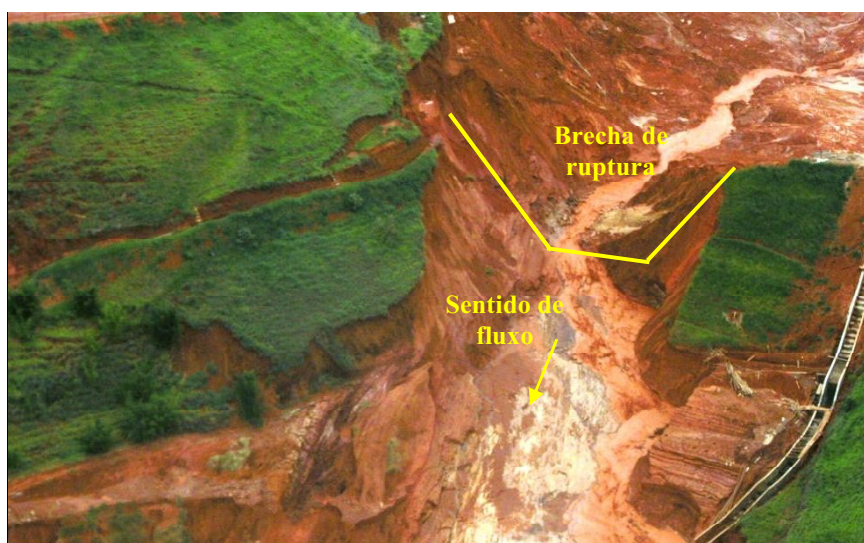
Ruptura do maciço da barragem São Francisco – detalhe da brecha de ruptura: vista frontal de jusante para montante
